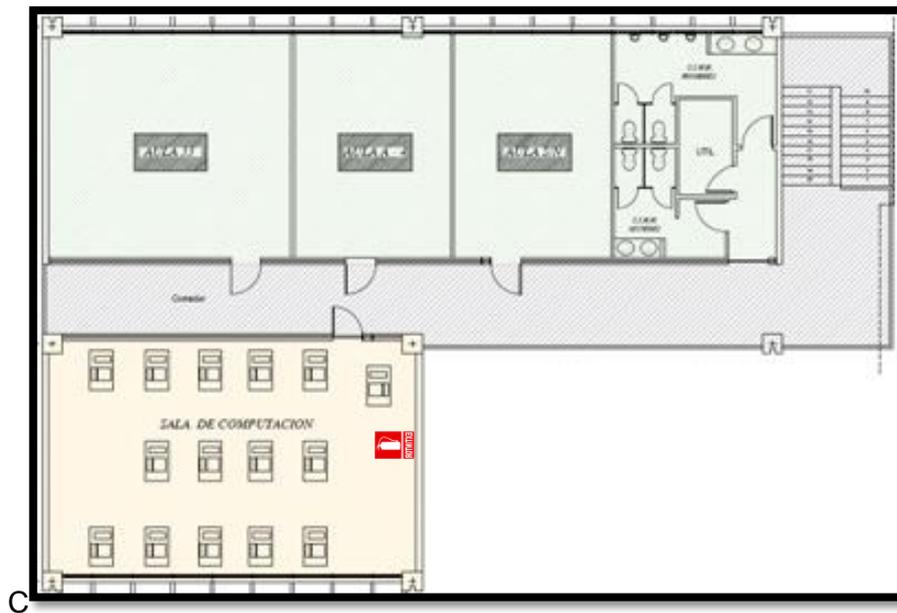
Extintores, Planta alta, Edificio 24-D, Zona 3.
